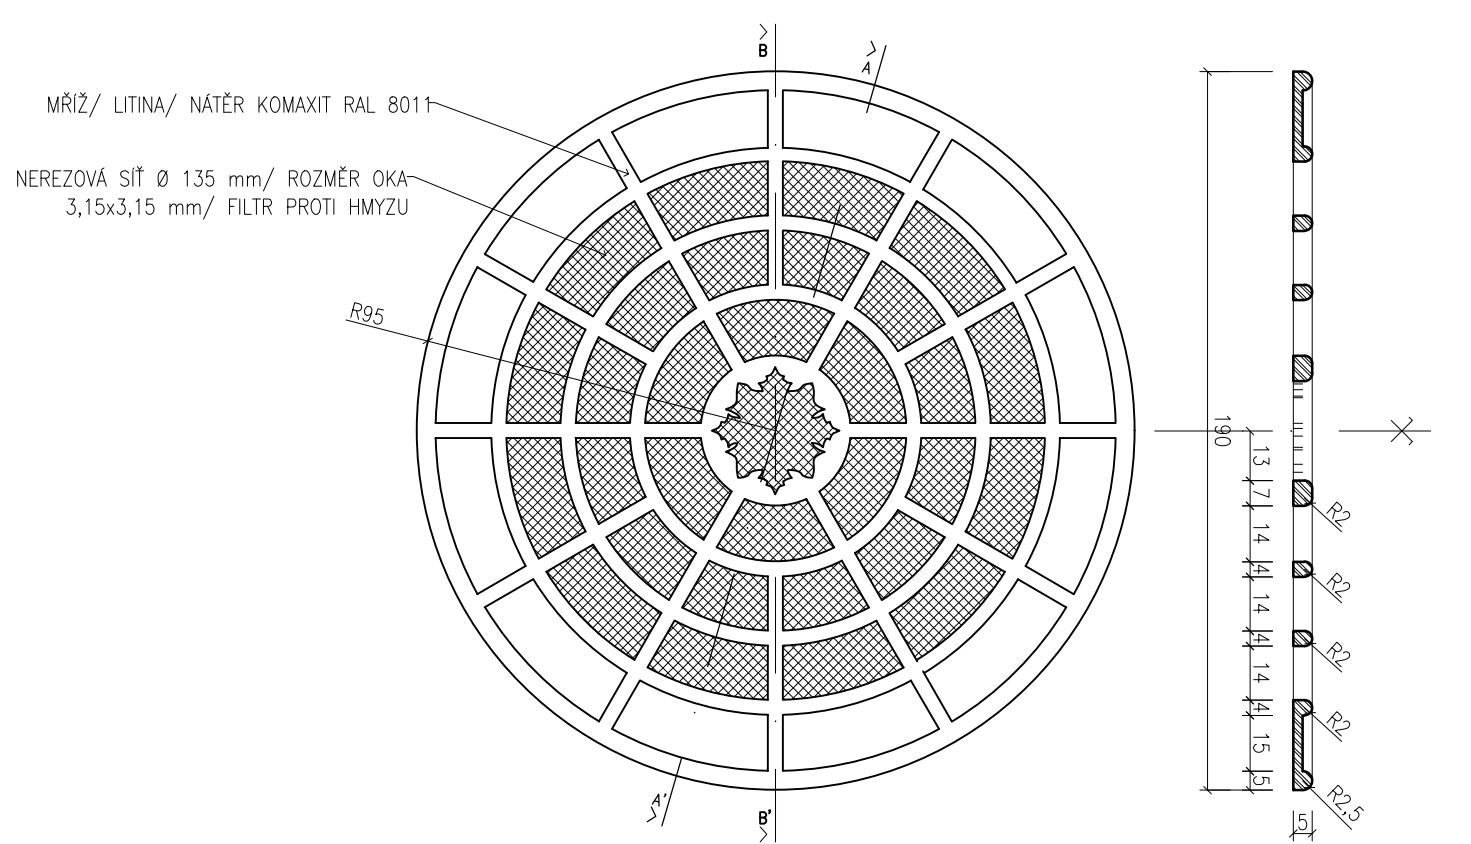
DETAIL / VĚTRÁNÍ SKLEPA /M 1:10/
